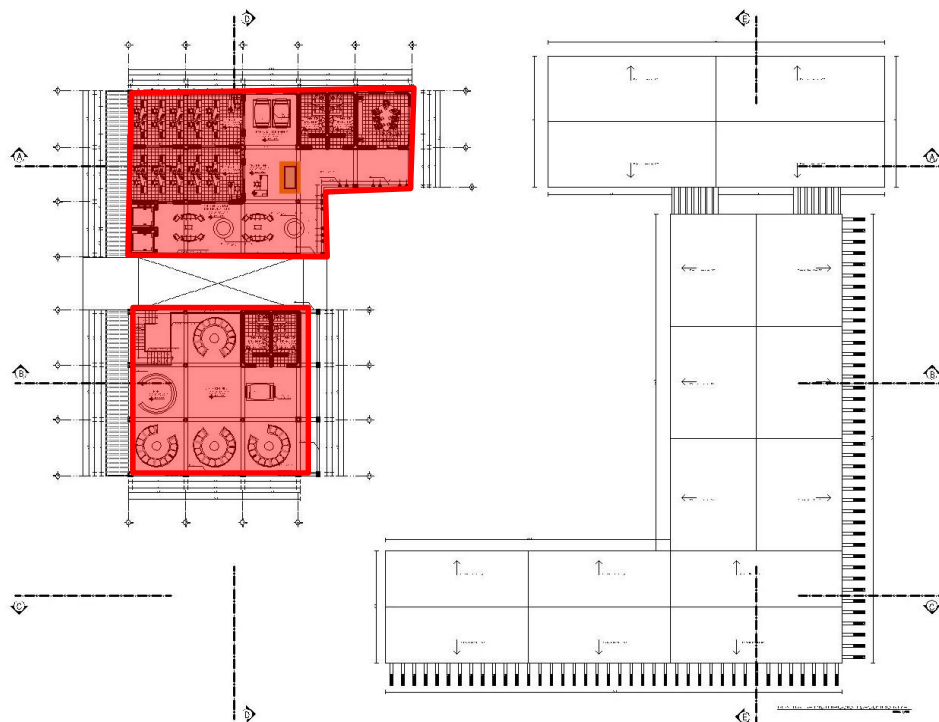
Plano Zonificado de Proyecto-Segundo Nivel
